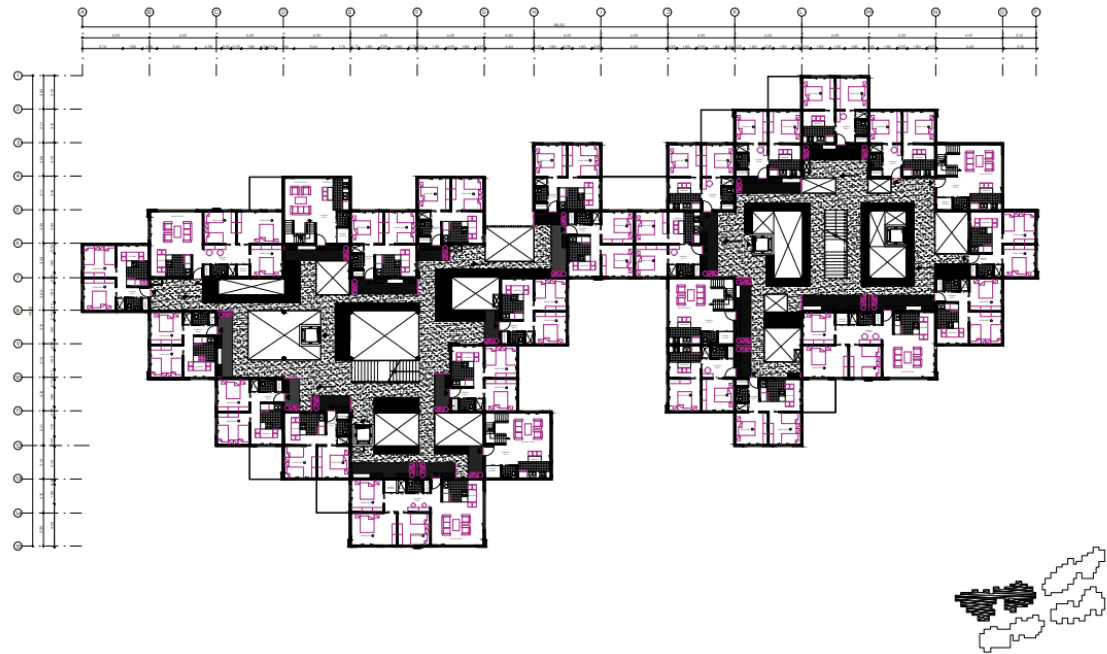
Planta Baja Bloque 4. Elaboración propia 2023
